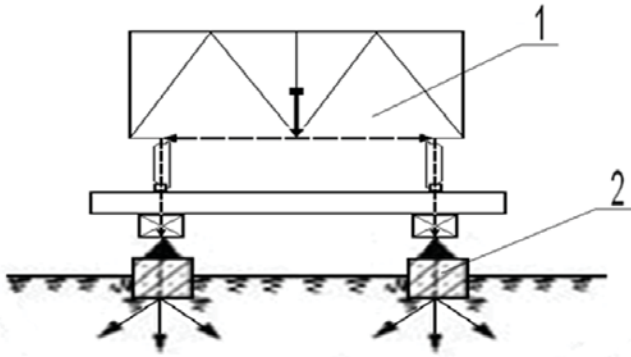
Схема діючих зусиль на вантажоприймальну платформу, фундамент, підстильну підставу, тощо від розташованих на платформі еталонних гир або баластного вантажу при штатному навантаженні ваг у експлуатації або при повірці, де 1- баластний вантаж; 2- фундамент.
